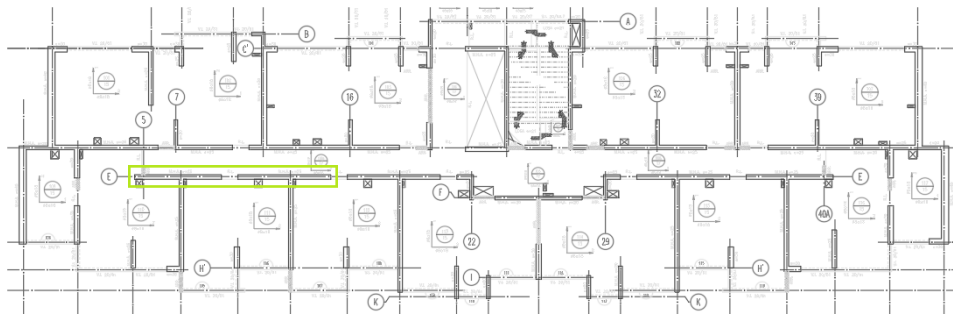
Planta piso tipo, edificio de mayor altura.
